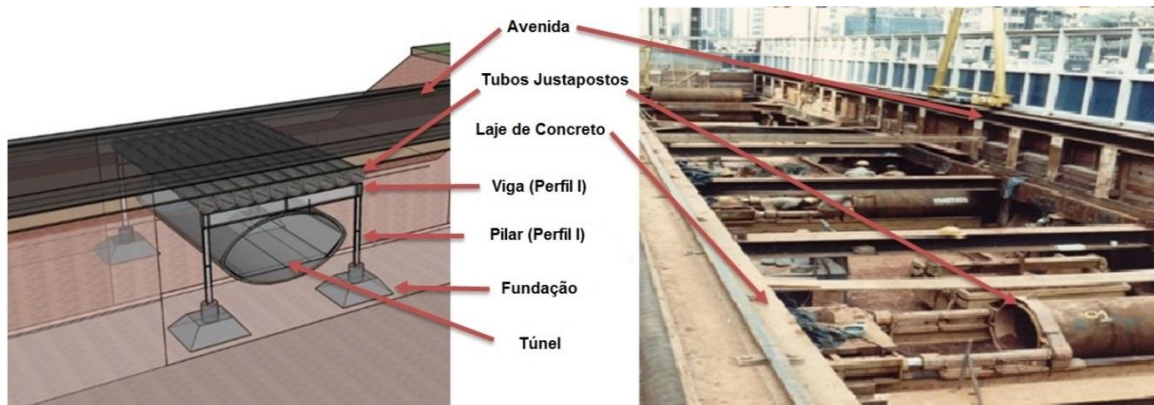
Concepção esquemática do pódio que provê estabilidade à escavação.
